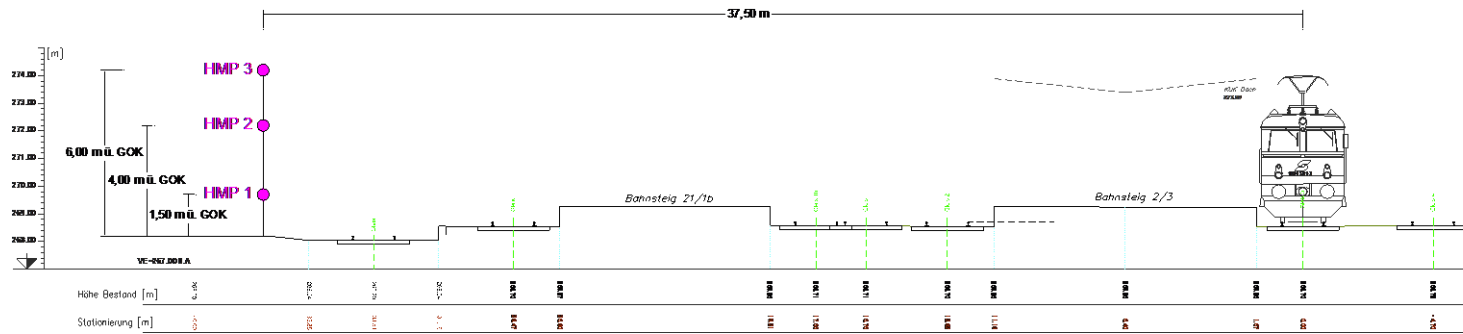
Lageplan zur Messgeometrie am Bahnhof Wr. Neustadt.
